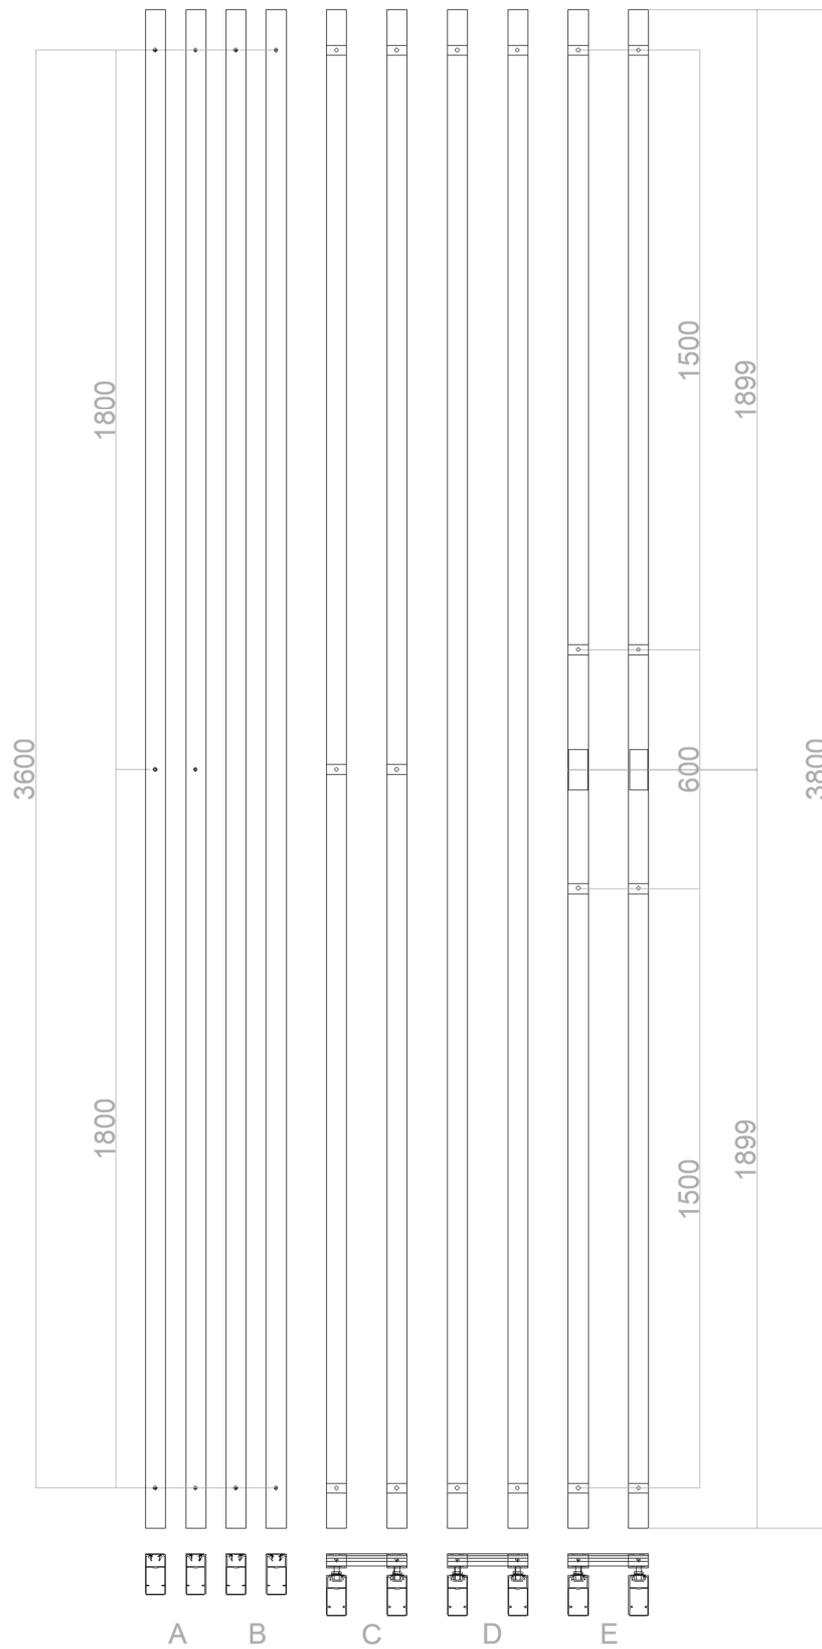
Prospetto e sezione del campione sottoposto a prova_Batters 50
